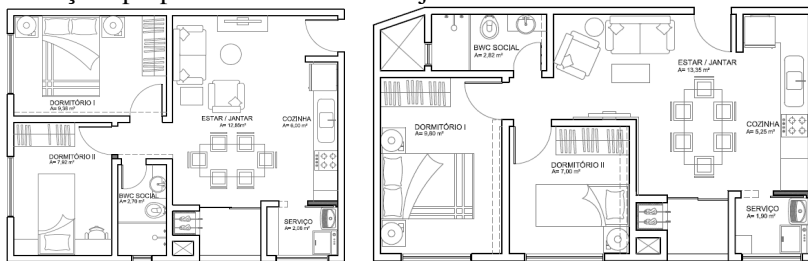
a) Planta baixa da habitação Tipo A. b) Planta baixa da habitação Tipo B.
